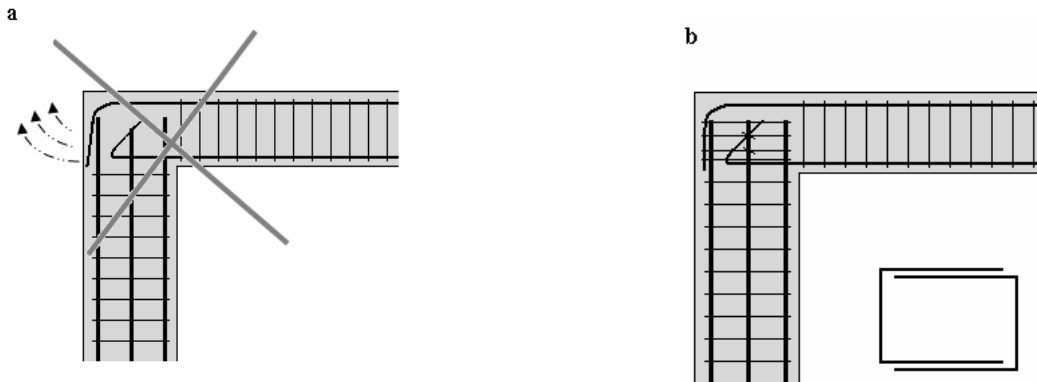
Continuité mécanique du nœud poutre-poteau.
